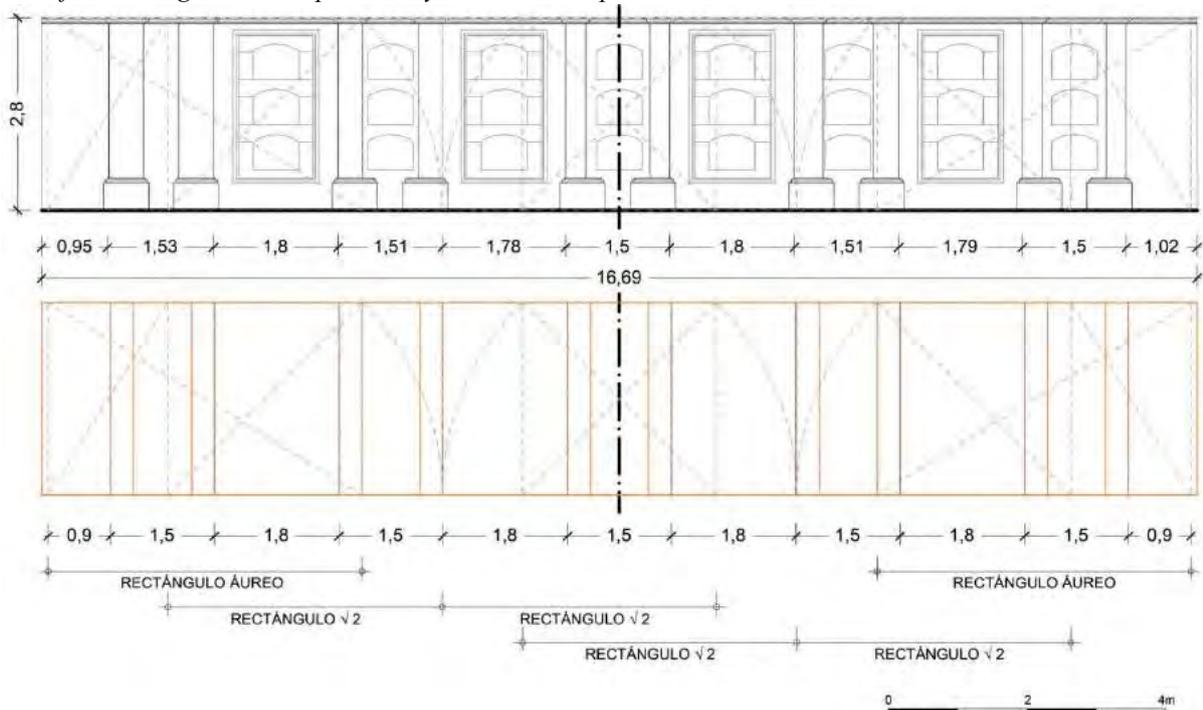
Plano de fachada del pabellón Canónigos y la modulación del mismo.
